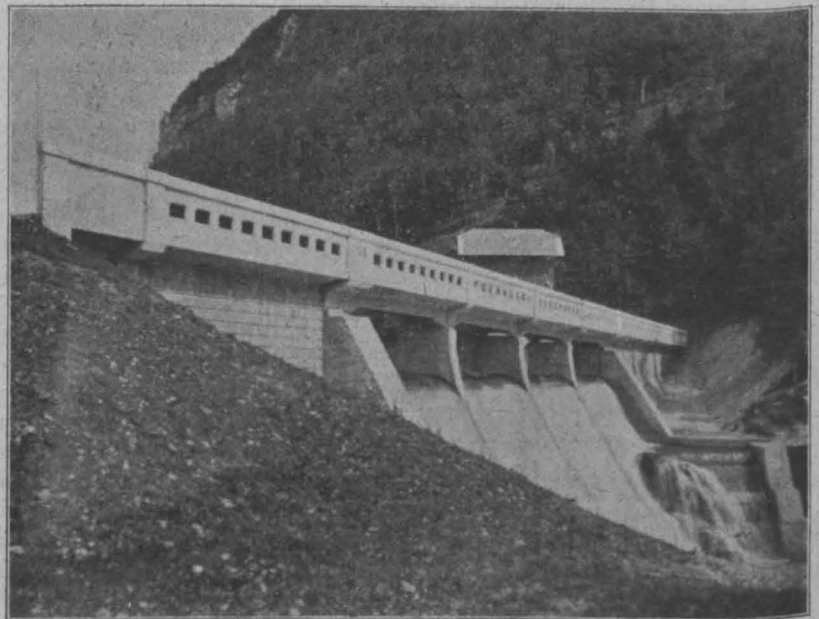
Luftseitige Ansicht der betonierten Sperrmauer mit Hochwasserüberfall in der Mauerkrone.
